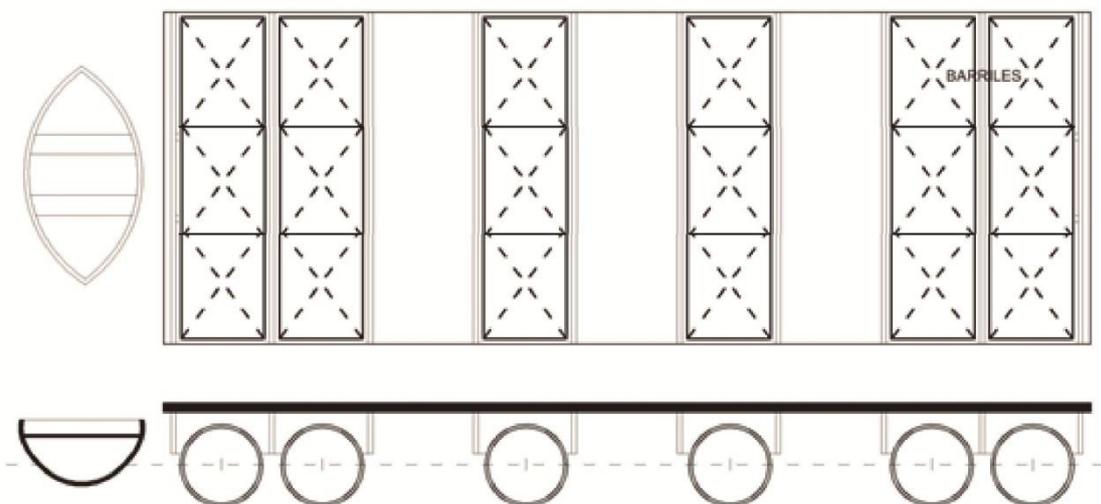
Planta y corte arquitectónico de una plataforma sobre barriles de acero sencilla.
